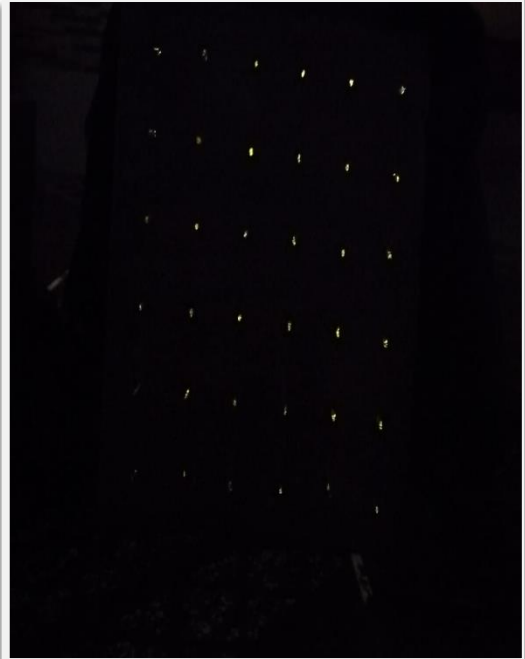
Elaboración de las vigas de hormigón translúcido
